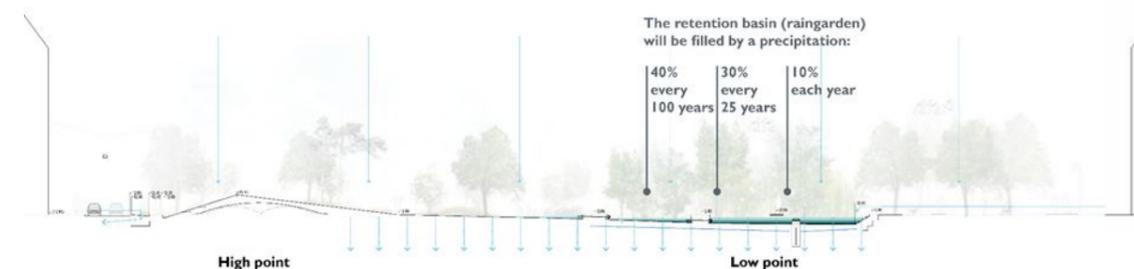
Corte esquemático com plano de drenagem da praça Tasinge Plads
